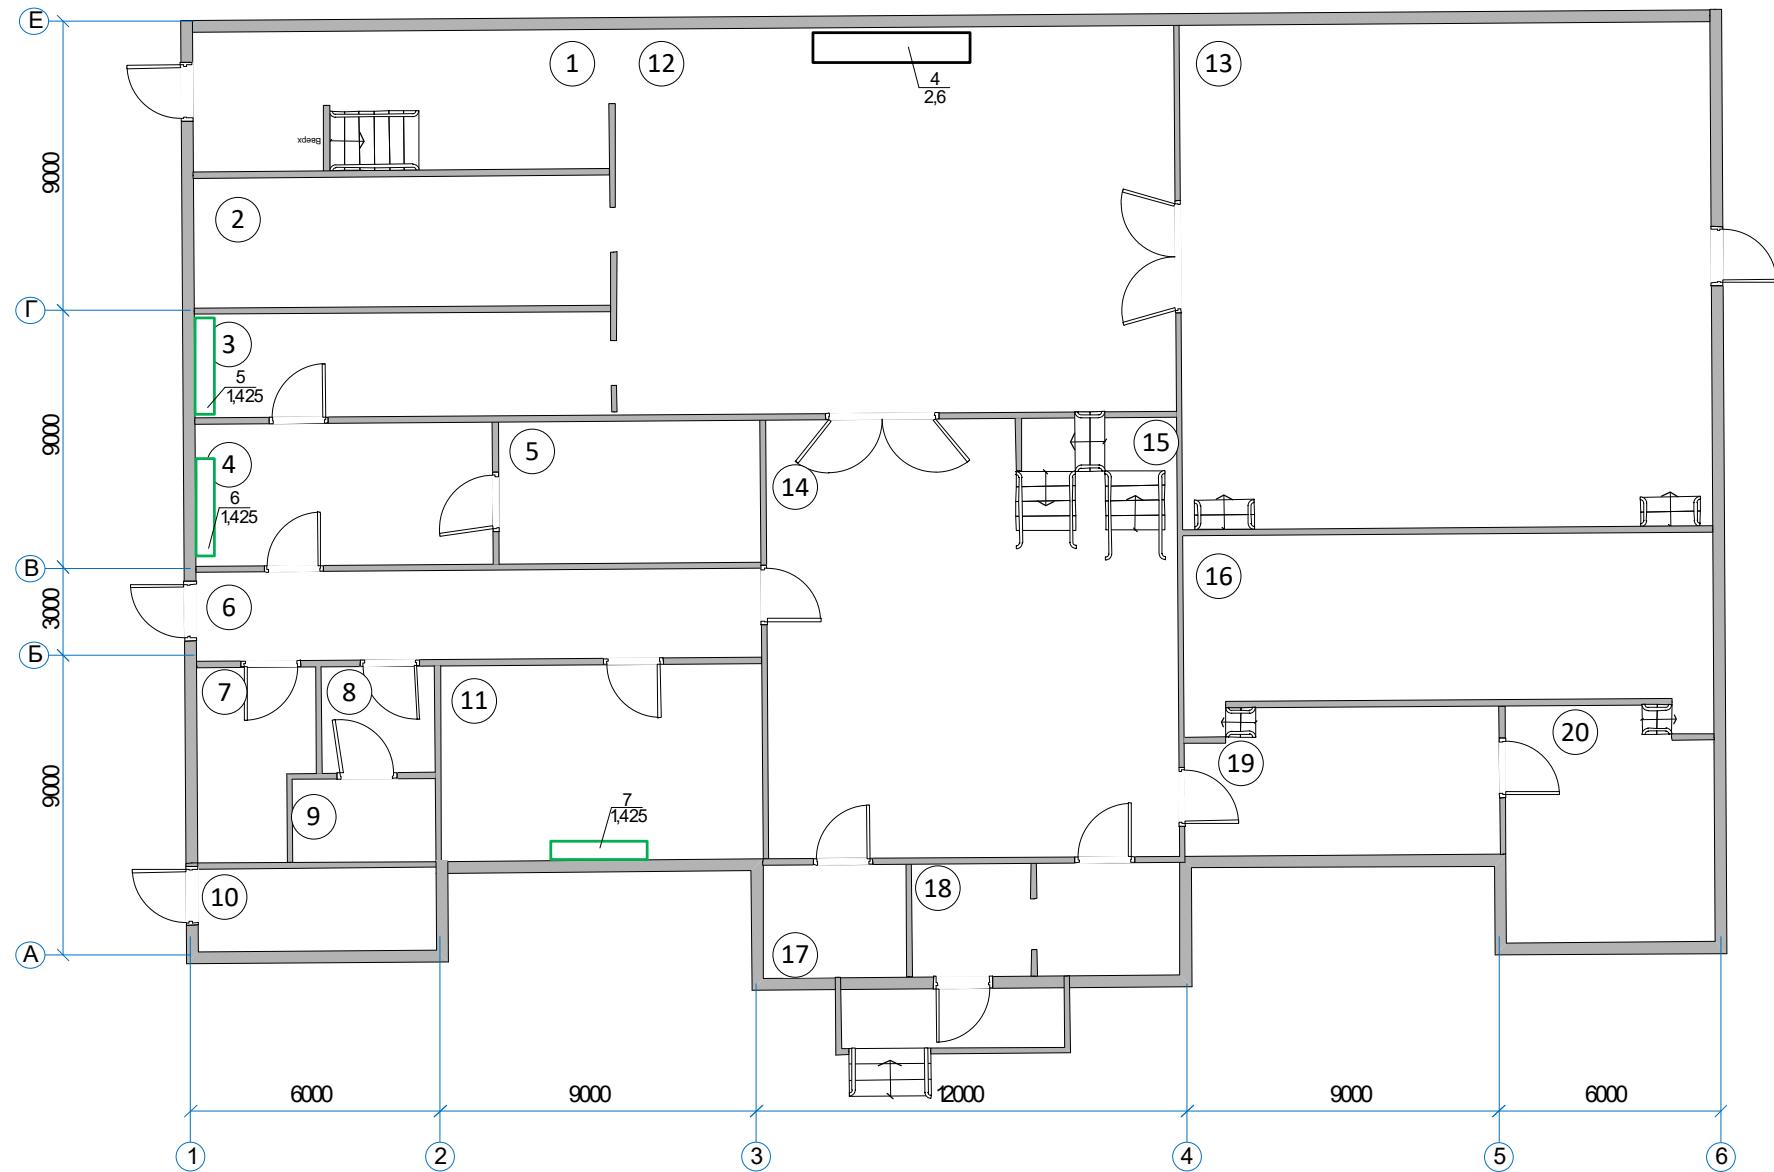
План расстановки электрооборудования на 1-м этаже
